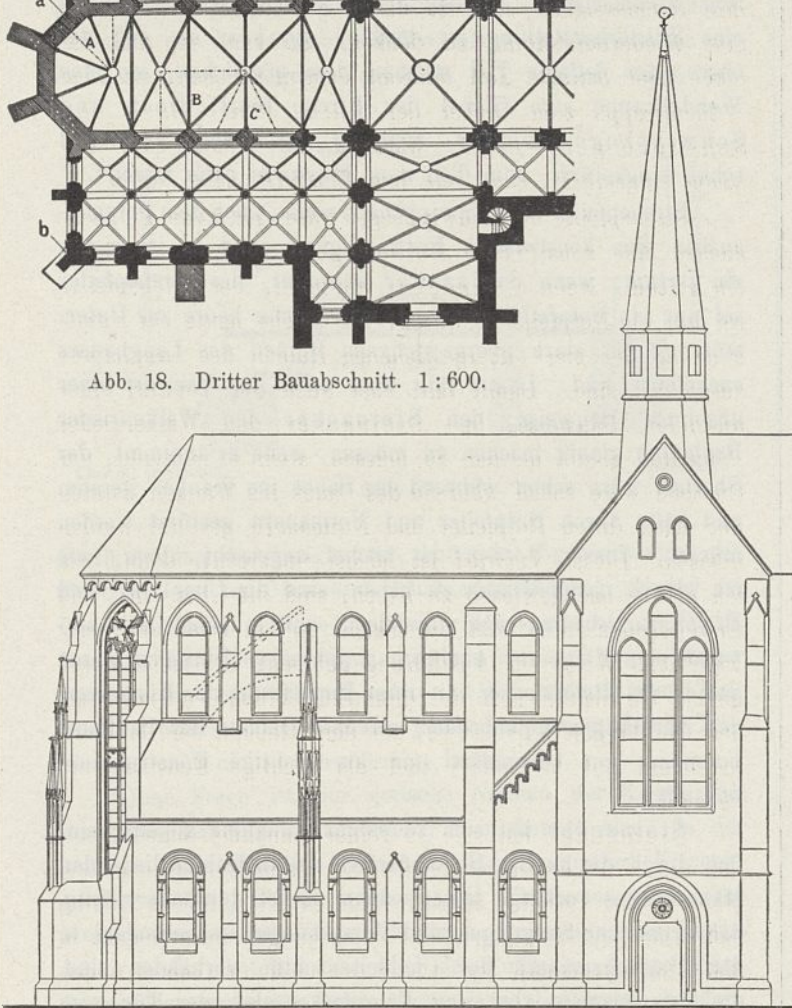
Walkenried. Chor. Dritter Bauabschnitt. Rekonstruktion. 1:400.
